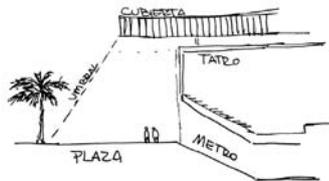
Esquema de planimetrías, planta y fachadas, etapa VI
